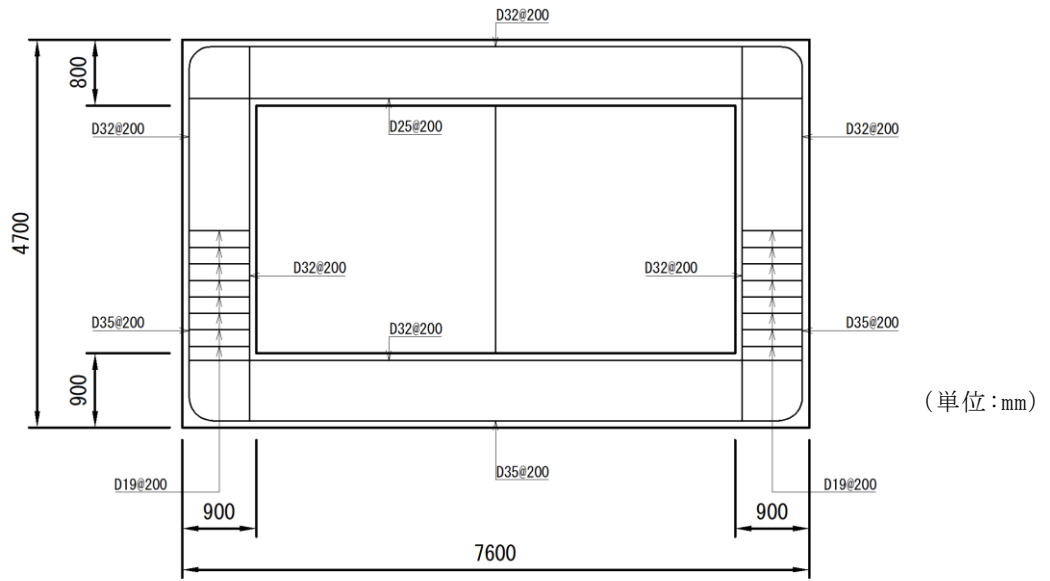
屋外配管ダクト (タービン建物～放水槽) 概略配筋図 (C-C 断面)
